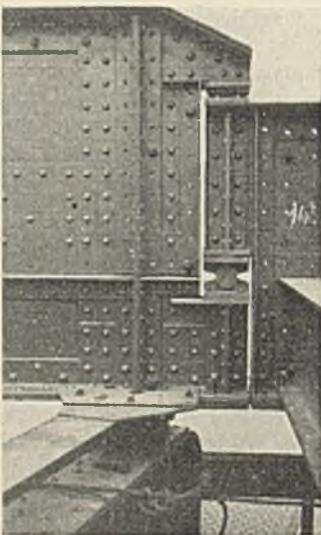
Gelenkausbildung der Hauptträger der Seitenöffnung, eingeschoben in den Hauptträger der Mittelöffnung.
